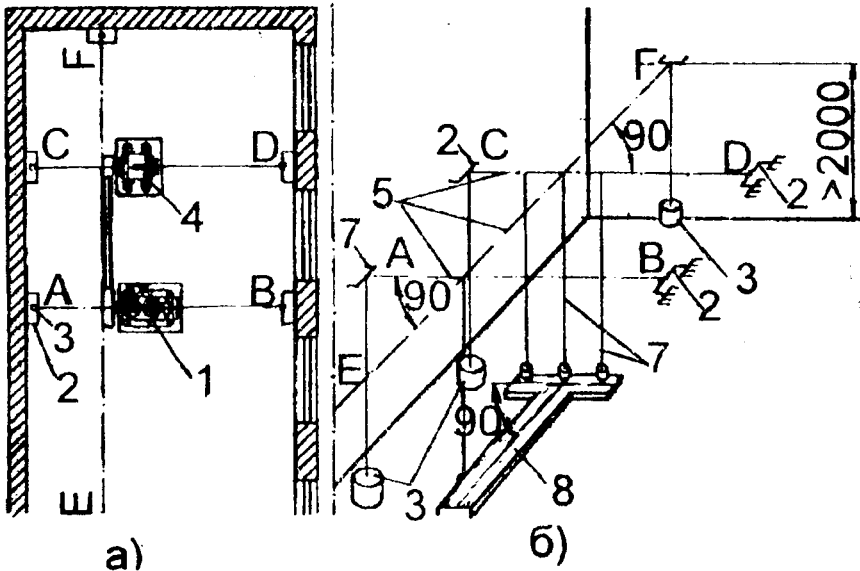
Разметка главных монтажных осей вертикального компрессора и электродвигателя
